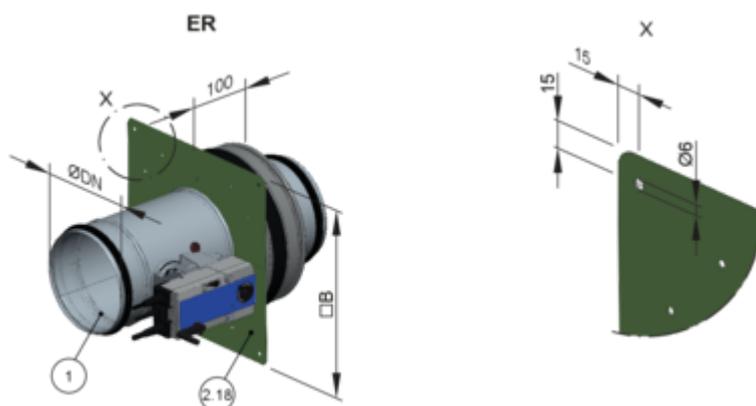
Visão geral do bloco de montagem e dos kits de montagem
